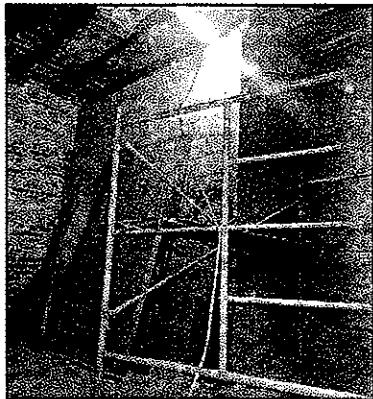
IMAGEN: Desplante de muros divisorios a base de block en planta baja
